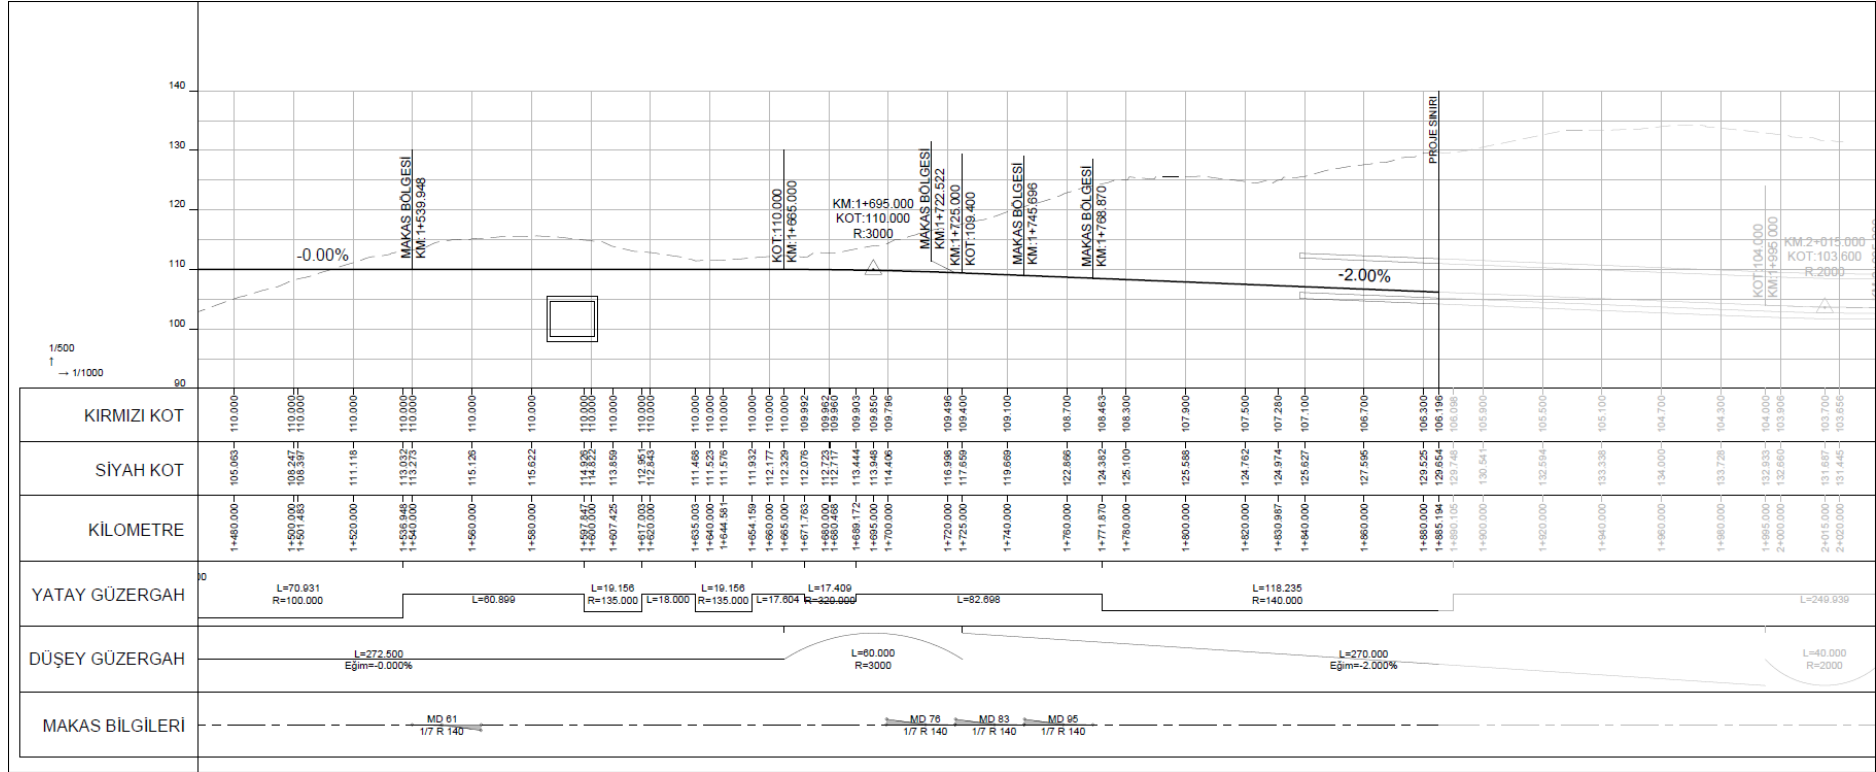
D02 hattı 0+500-1+000 kilometreleri arası profili.
